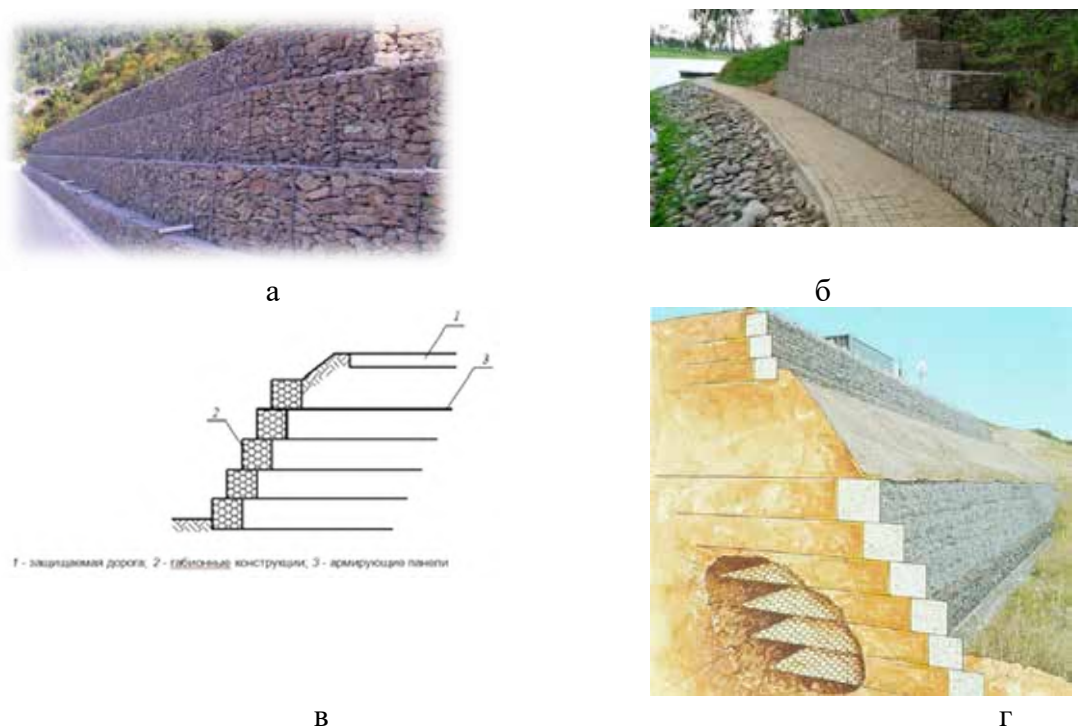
Подпорная стена из габрионов: а, б – примеры стен из габрионов; в, г – комбинированные стены из габрионов и армирующих панелей
